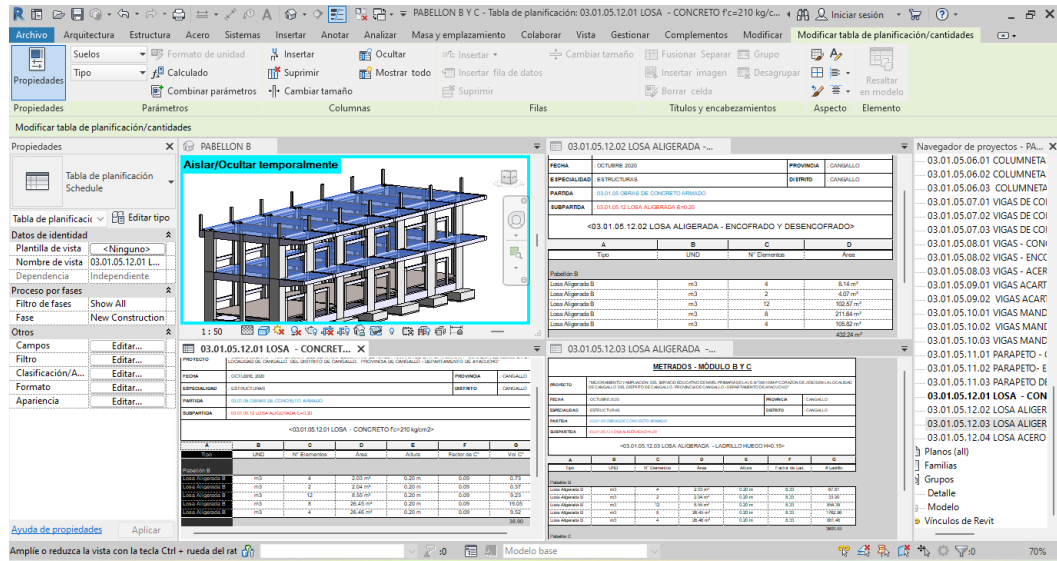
Modelado y metrados de la partida Losa Aligerada Modulo B y C.
